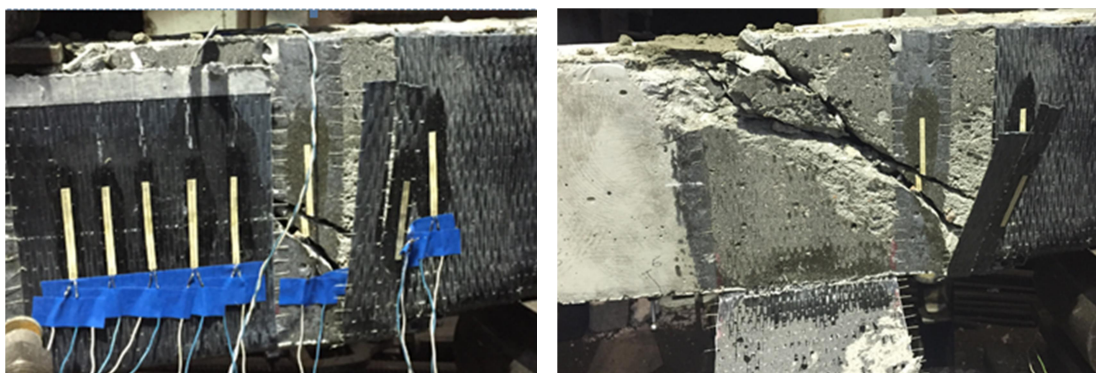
Вид разрушенной опорной зоны балки после испытаний и после демонтажа сетки усиления
